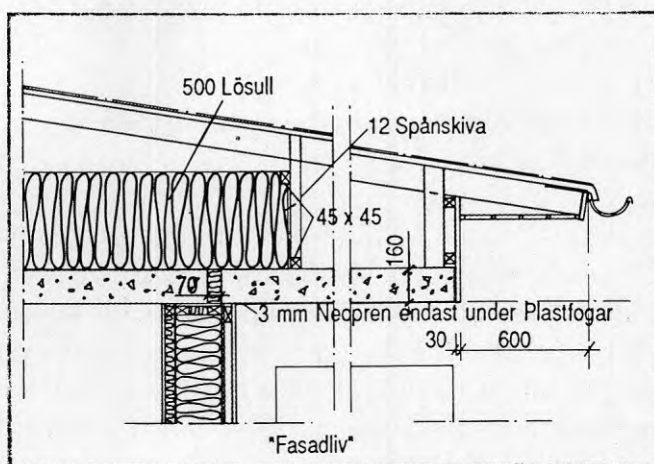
Anslutningen mellan lättregelvägg och vindbjälklag i Sjuksköterskan. Över loftgång vilar vindbjälklagets betongplatta på betongramar. Köldbryggan bryts av 70 mm isolering ovanför lättregelväggen.
